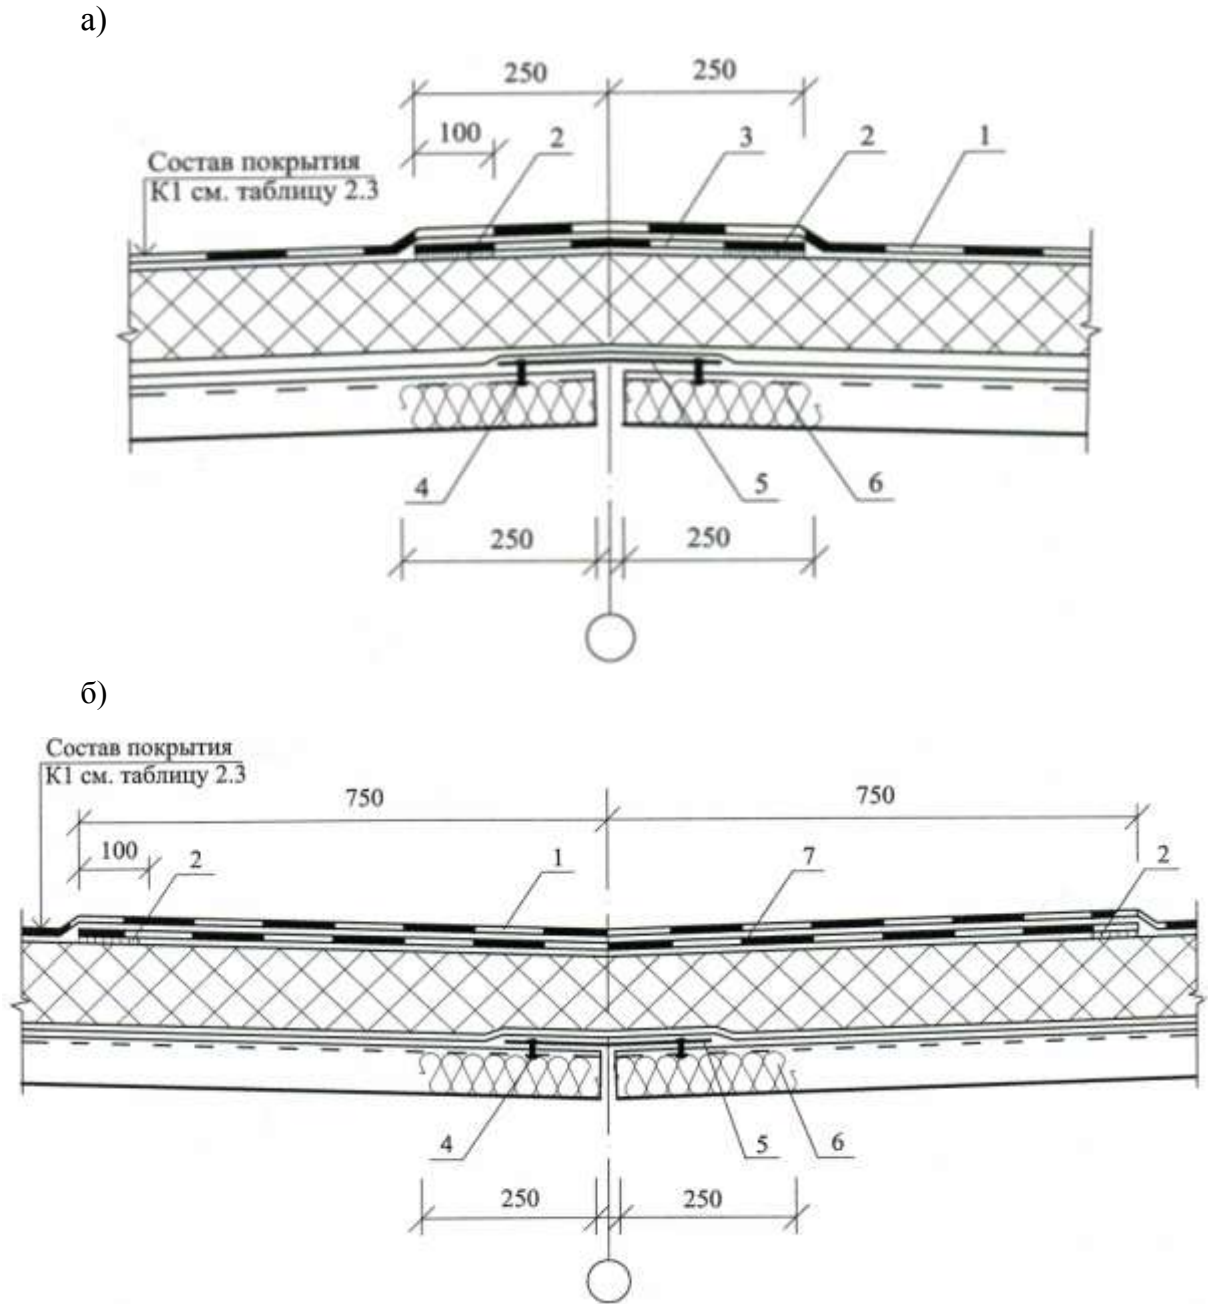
Конек а) и ендова б) кровли с несущим профилированным настилом
